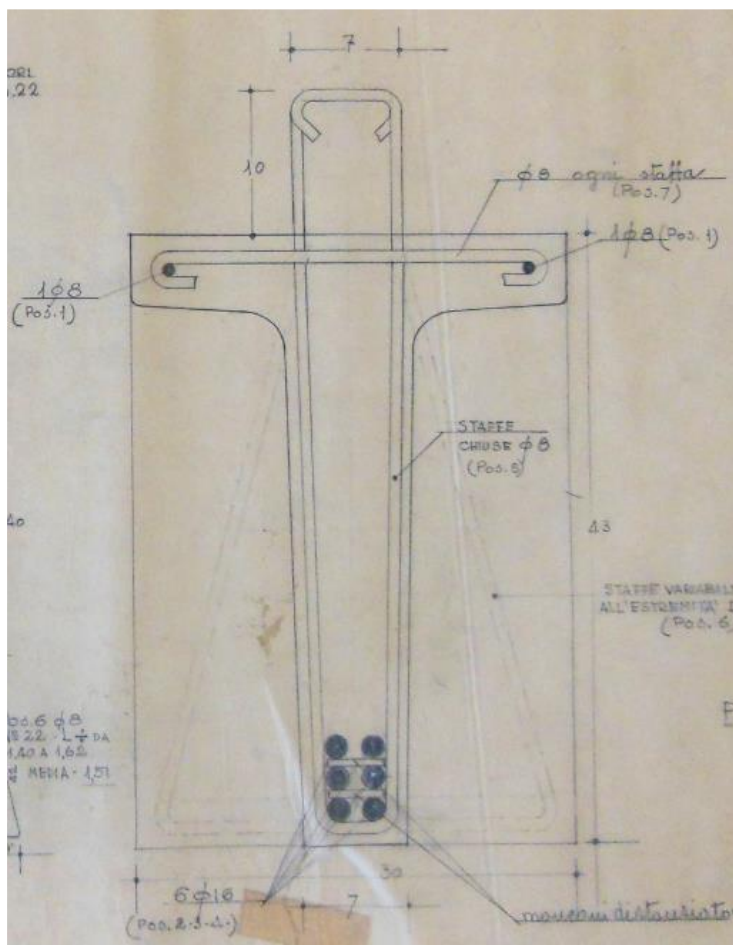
Sezione trave secondaria solaio in cemento armato, (Nervi, Tavole padiglione 2, Torino Esposizioni 1947)
